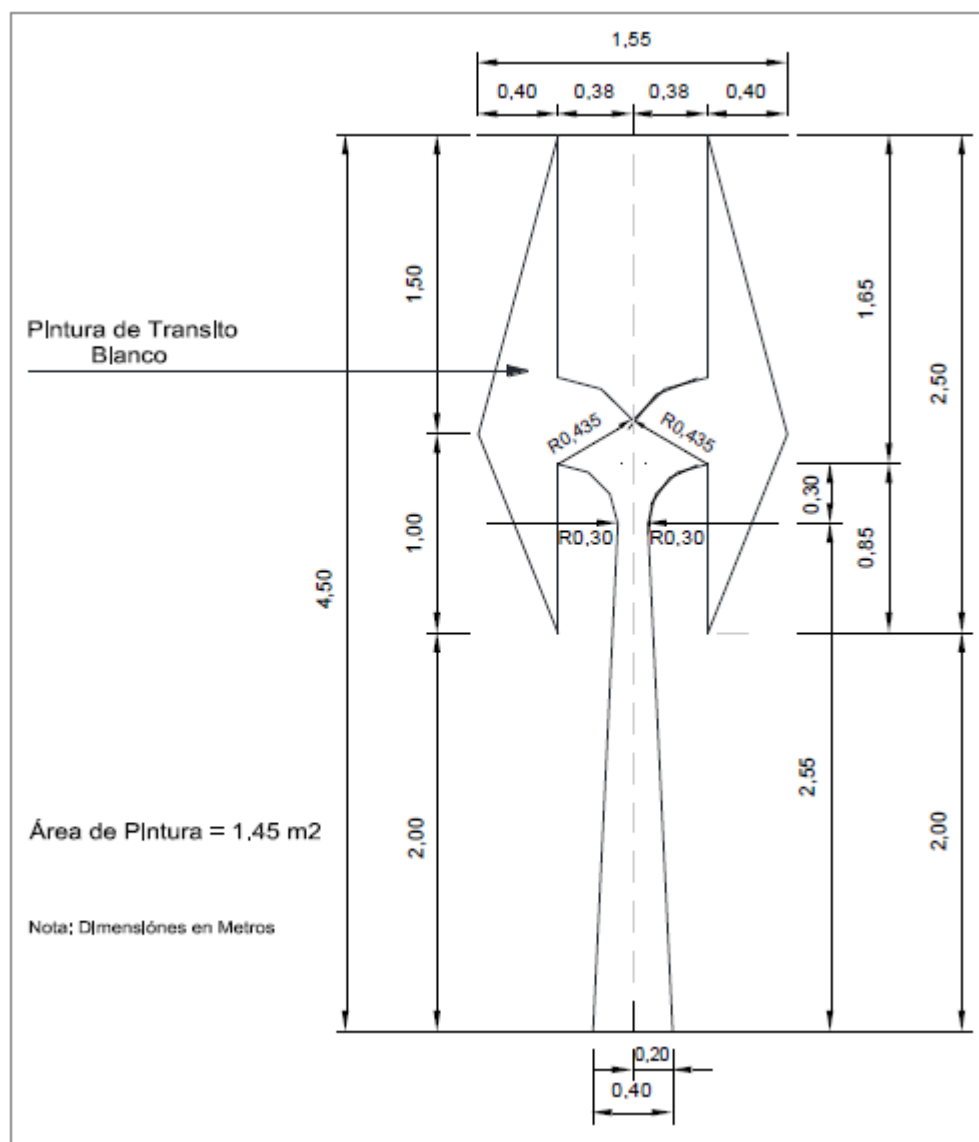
Dimensiones de flecha de giro a la derecha e izquierda.
